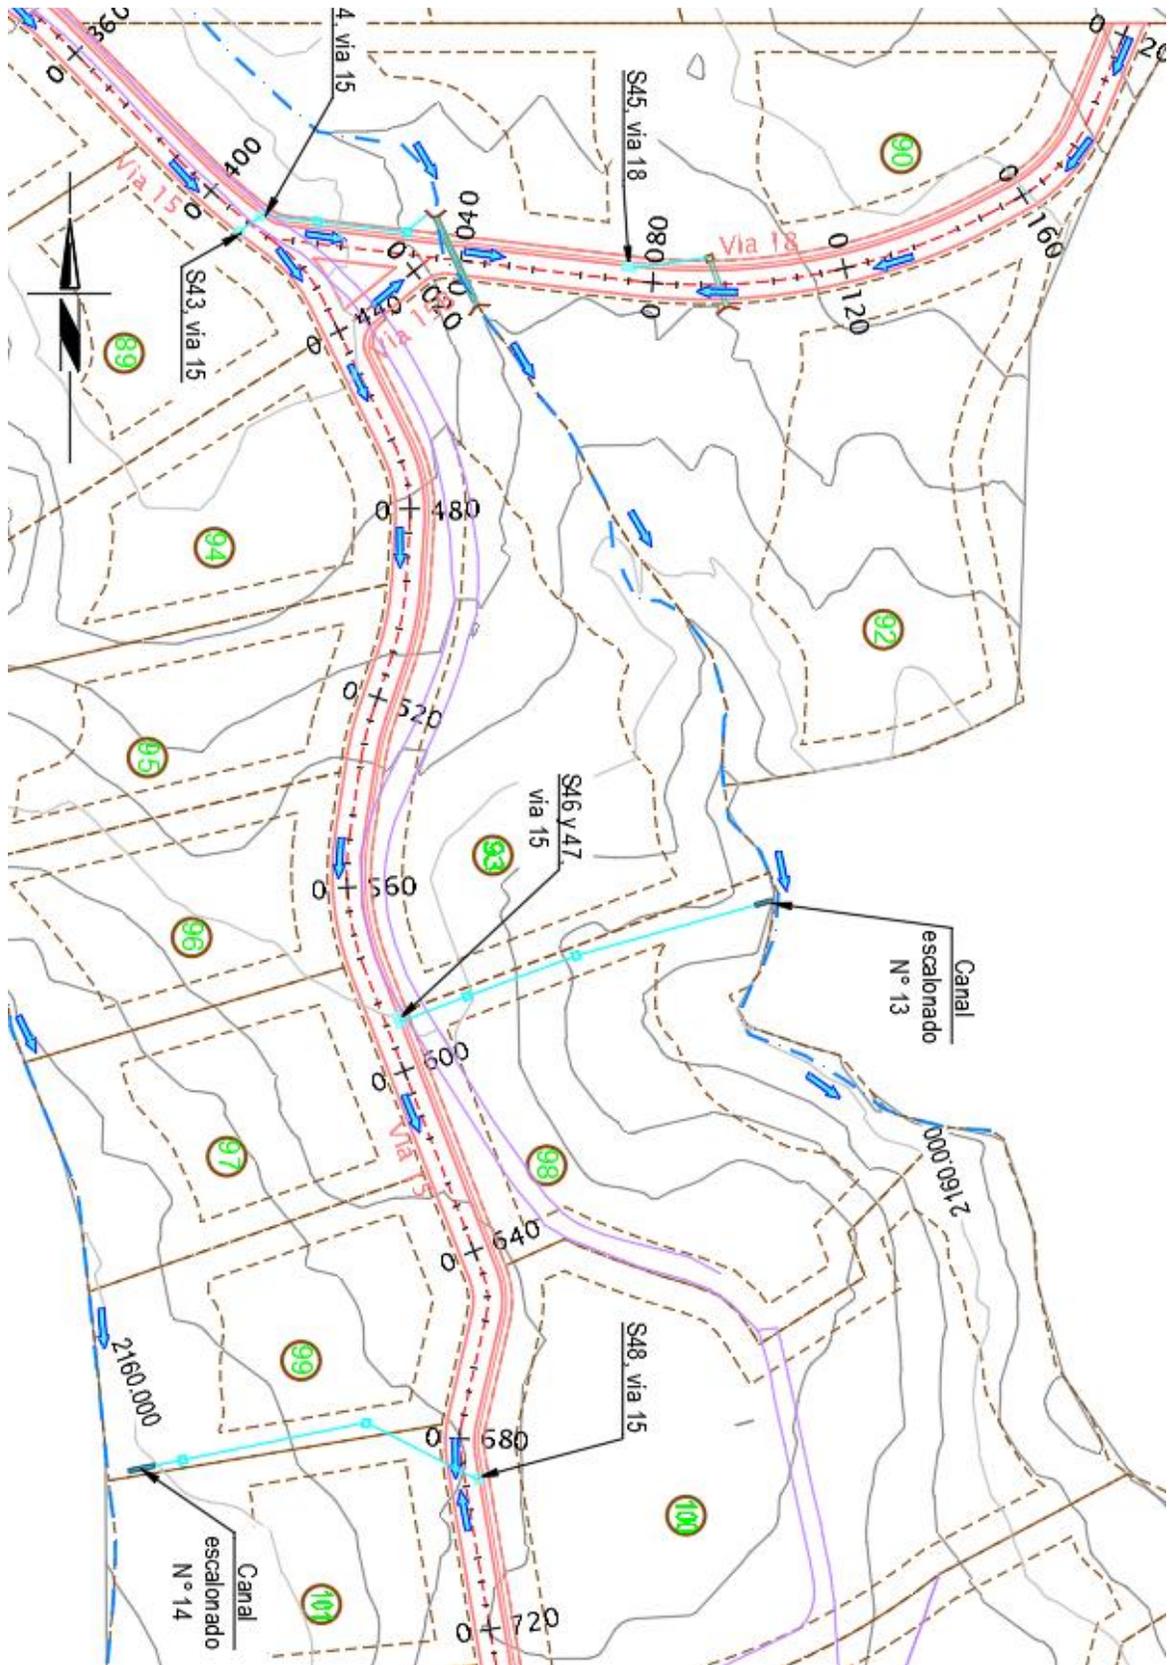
Planta de la red de lluvias para Essenza parte 1
